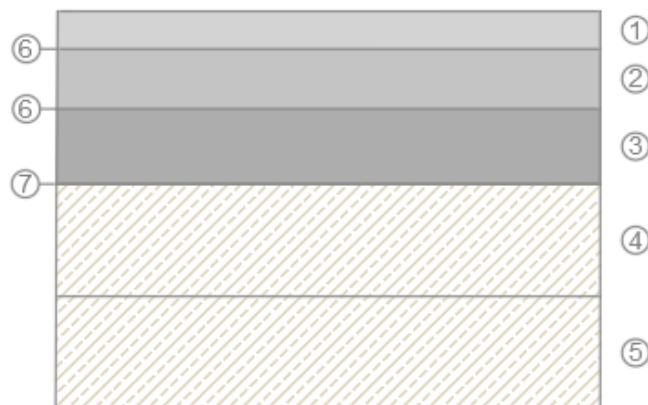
Estrutura do pavimento flexível a aplicar na VCU.
